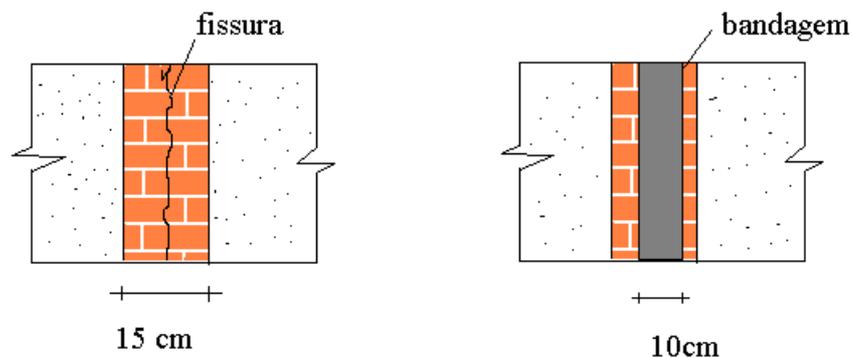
Técnica da bandagem para correção das fissuras
